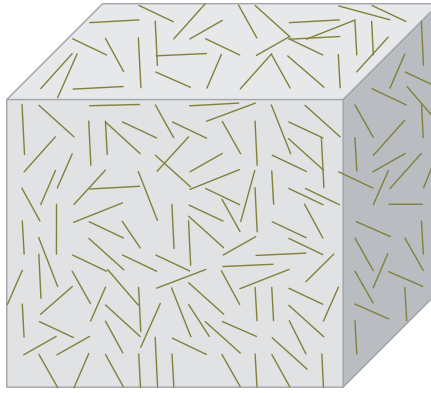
Дисперсное объемное армирование бетонов и асфальтобетонов
